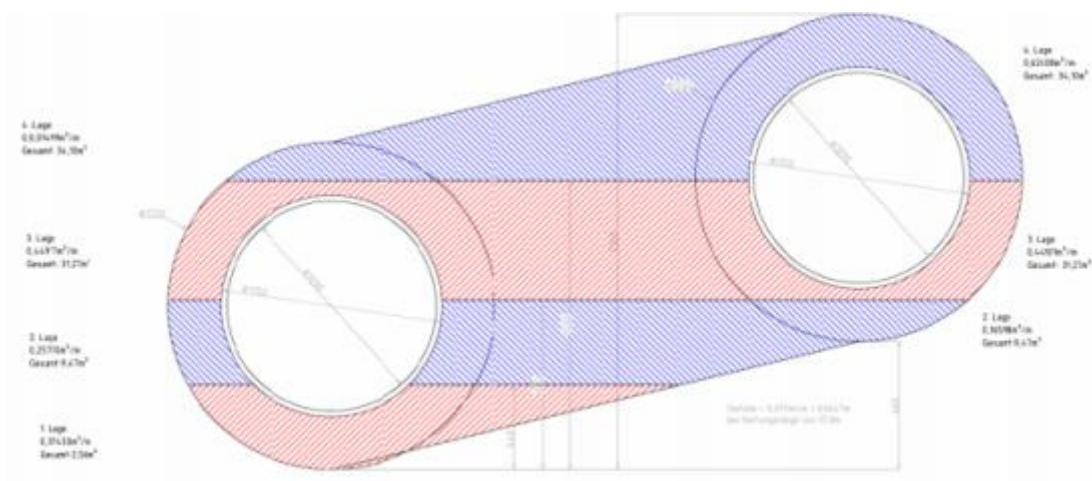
Cálculo do faseamento da injeção do grout (5)
